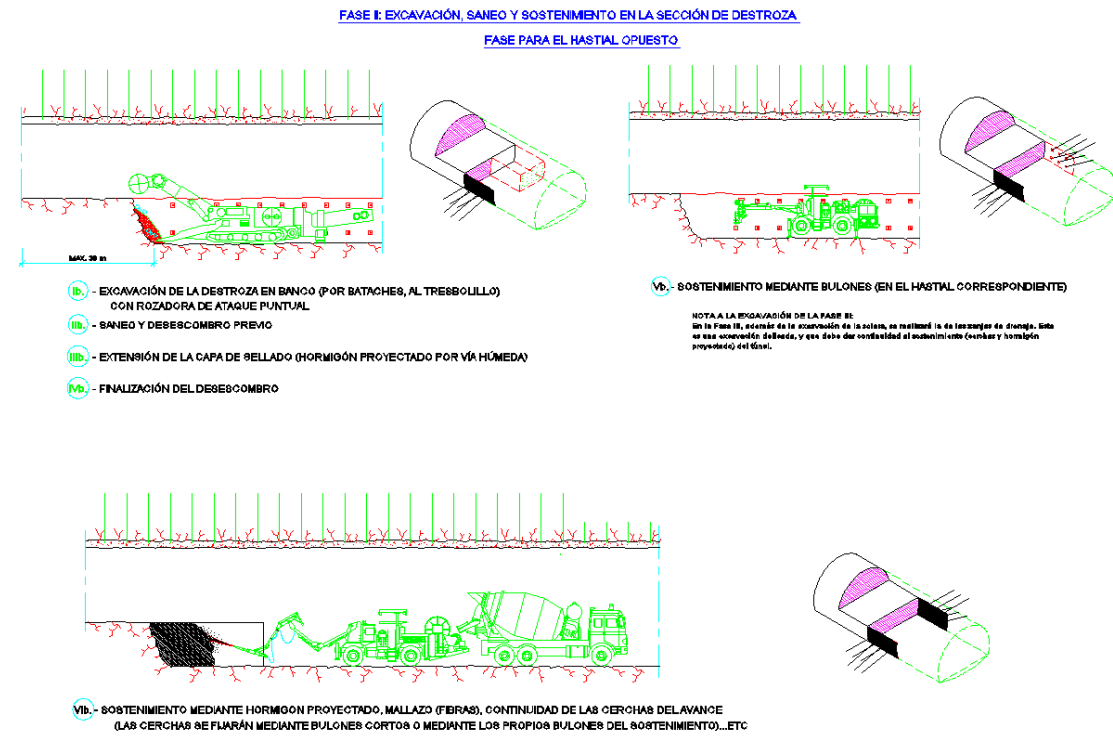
Fase de excavación en la sección de Destroza, hastial opuesto.
